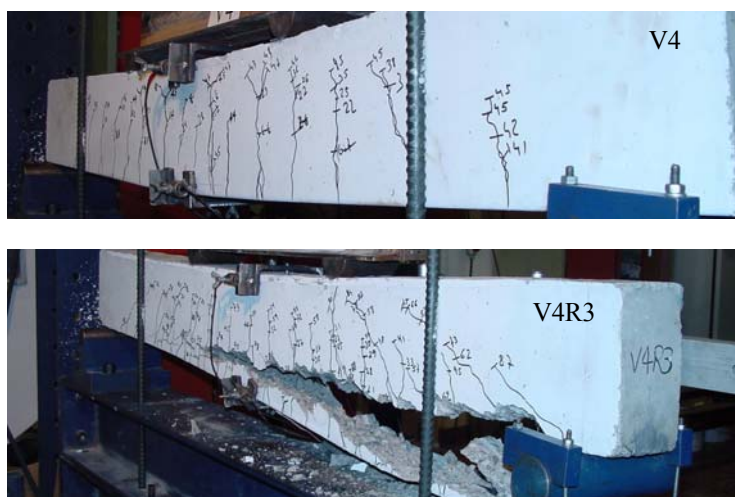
Modos típicos de rotura: viga de referência, V4, e correspondente viga reforçada, V4R3
